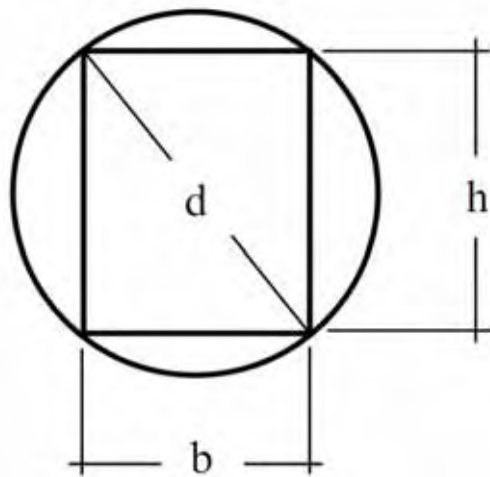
Peça de seção circular e respectiva seção retangular que pode ser obtida.
